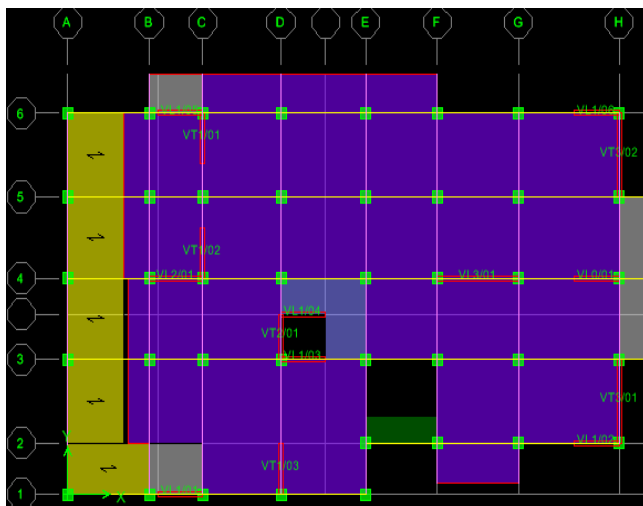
Vue en plan des éléments structuraux d'un étage RDC
